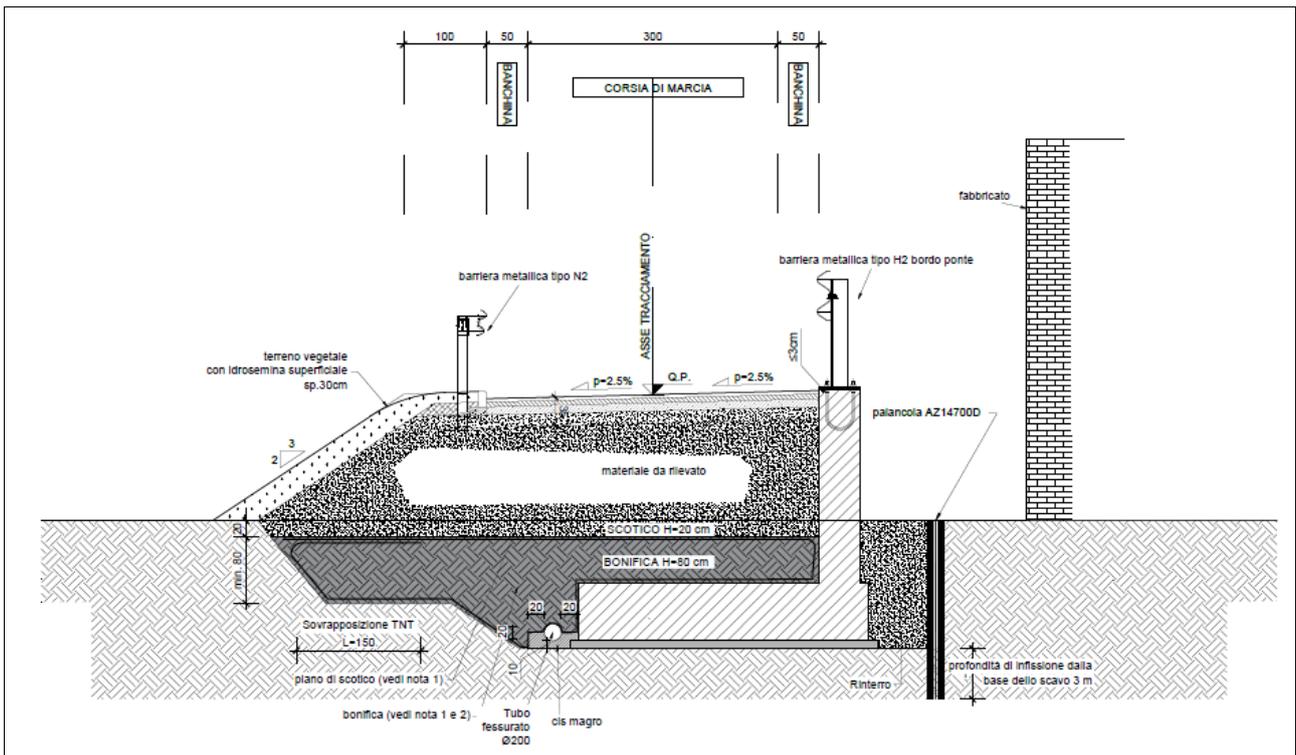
SEZIONE TIPOLOGICA DELLA RICUCITURA Ex SS38 – ELIPORTO IN RILEVATO CON MURO DI CONTENIMENTO IN SINISTRA A PROTEZIONE DEL FABBRICATO
